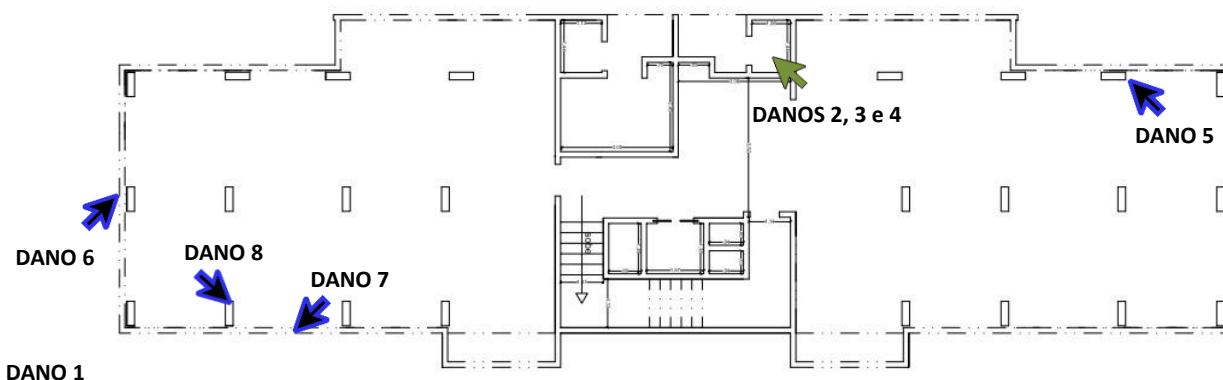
Planta Baixa (croqui) do pavimento térreo – Bloco B – Cond. Armando Lôbo.
